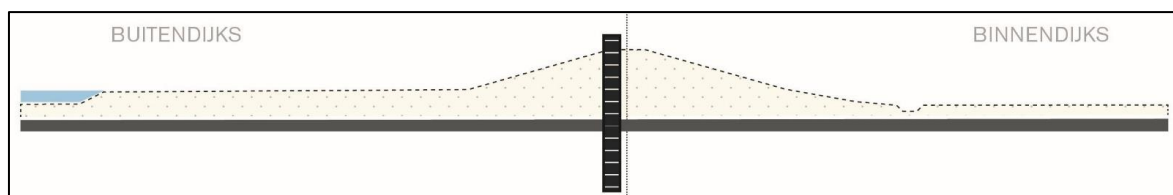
Alternatief D. Verschuiving in buitendijkse richting met buitendijkse klei-ingraving of verticale pipingvoorziening
